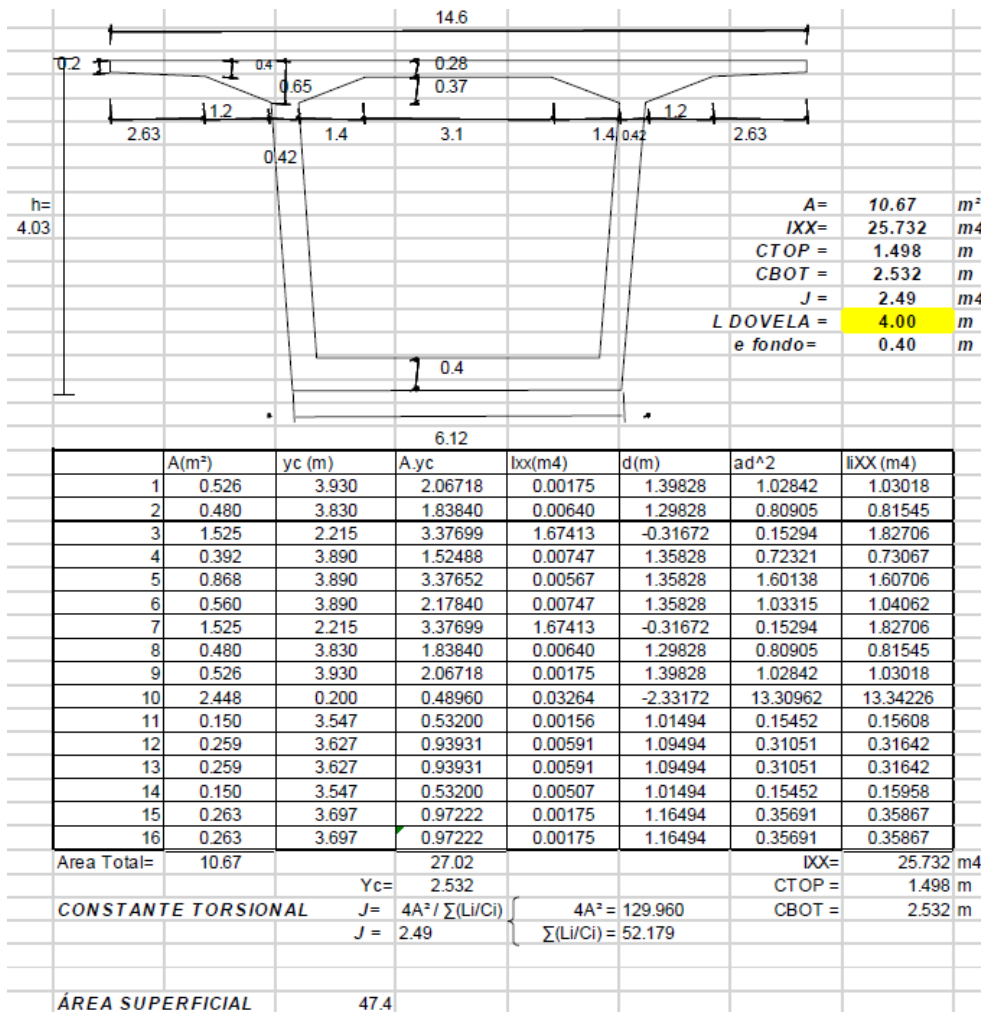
Dimensiones y propiedades de la viga cajón cara menor dovela 1 puente San Pedro.
